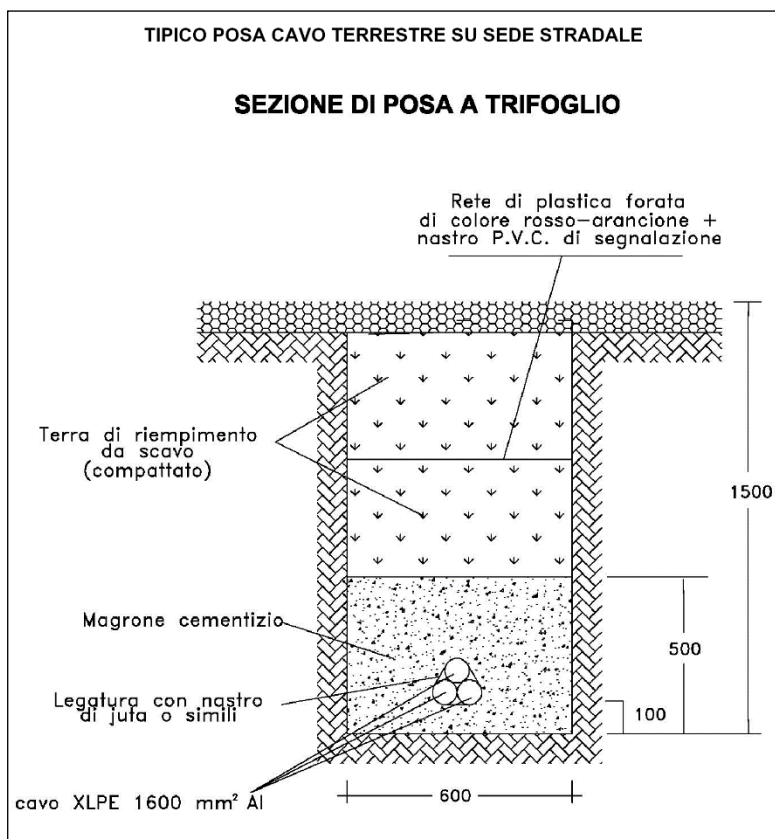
Tipico posa cavo terrestre su sede stradale
